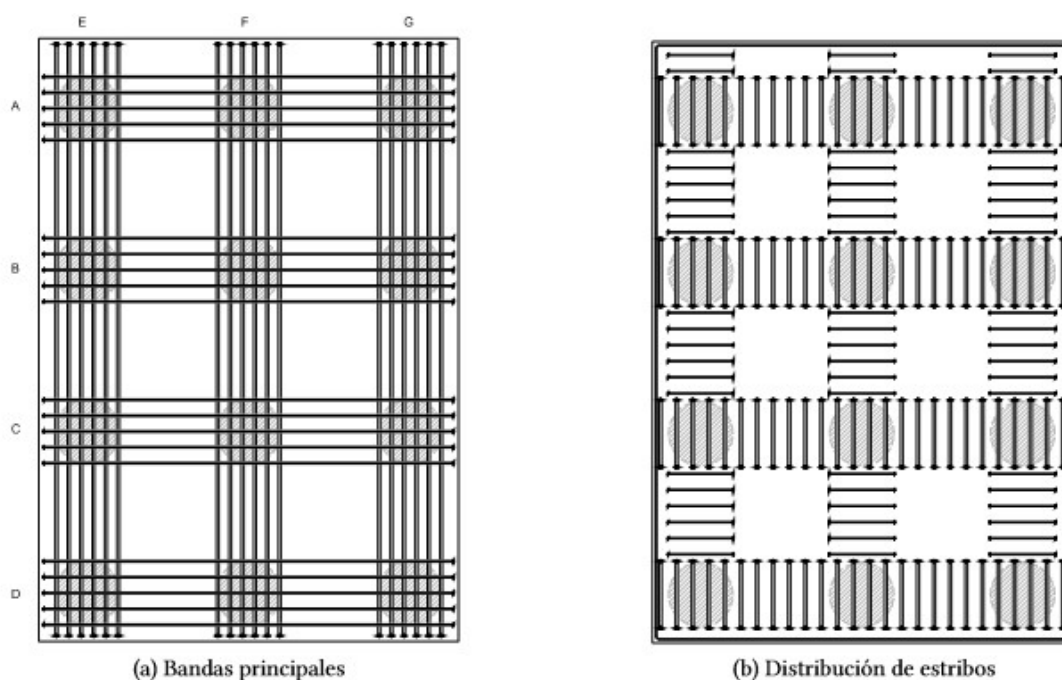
Cabezal de 12 pilotes armado
